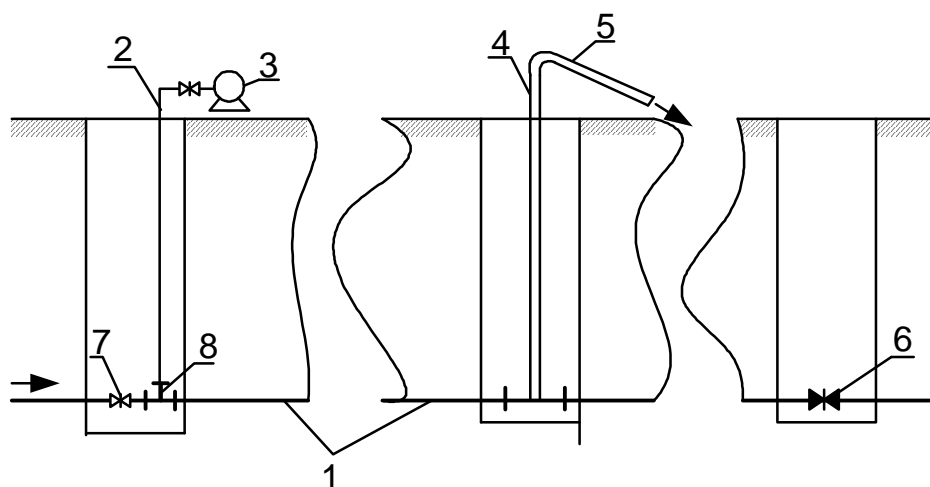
Схема гидропневматической промывки: 1 – промываемый участок; 2 – труба для подачи сжатого воздуха; 3 – компрессор; 4 – отводной стояк; 5 – шланг; 6 – закрытая задвижка; 7 – открытая задвижка; 8 – пожарная подставка
